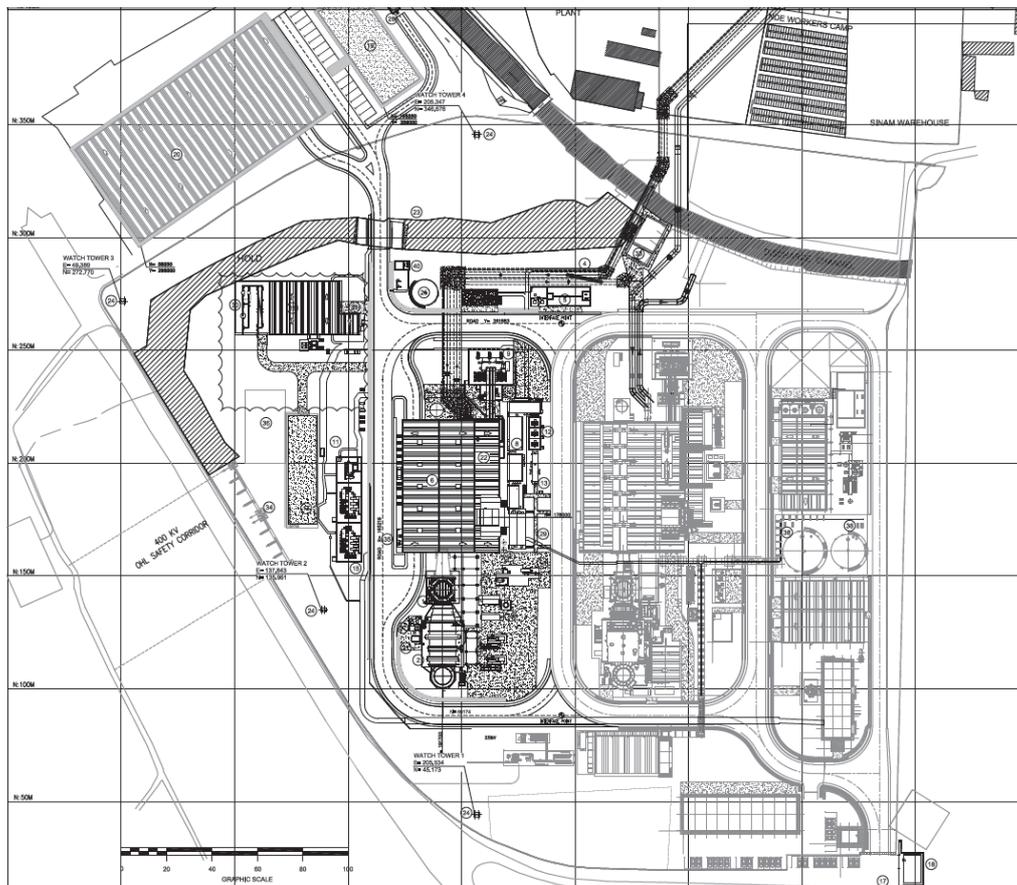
Planta técnica de la central. Fuente: Marmedsa Proyectos
